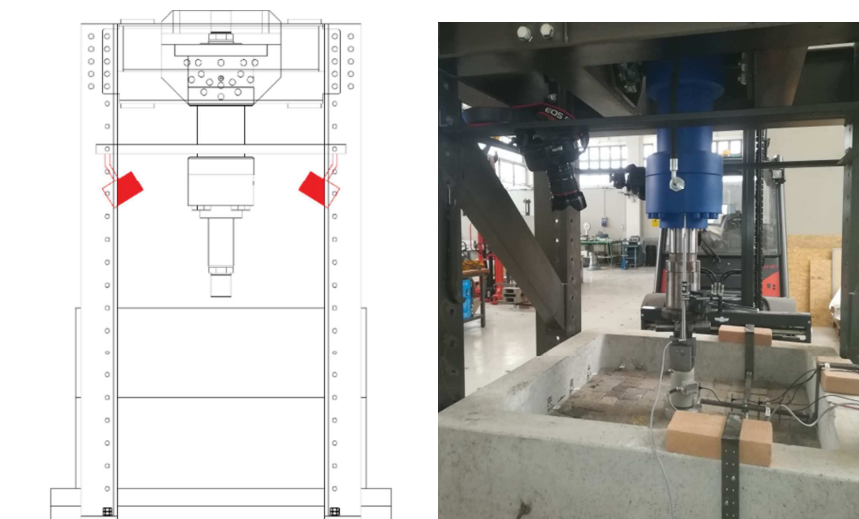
Disposizione delle due fotocamere per il rilievo fotogrammetrico della pavimentazione dello Schema 3 durante la realizzazione della prova con pressa dinamica.
